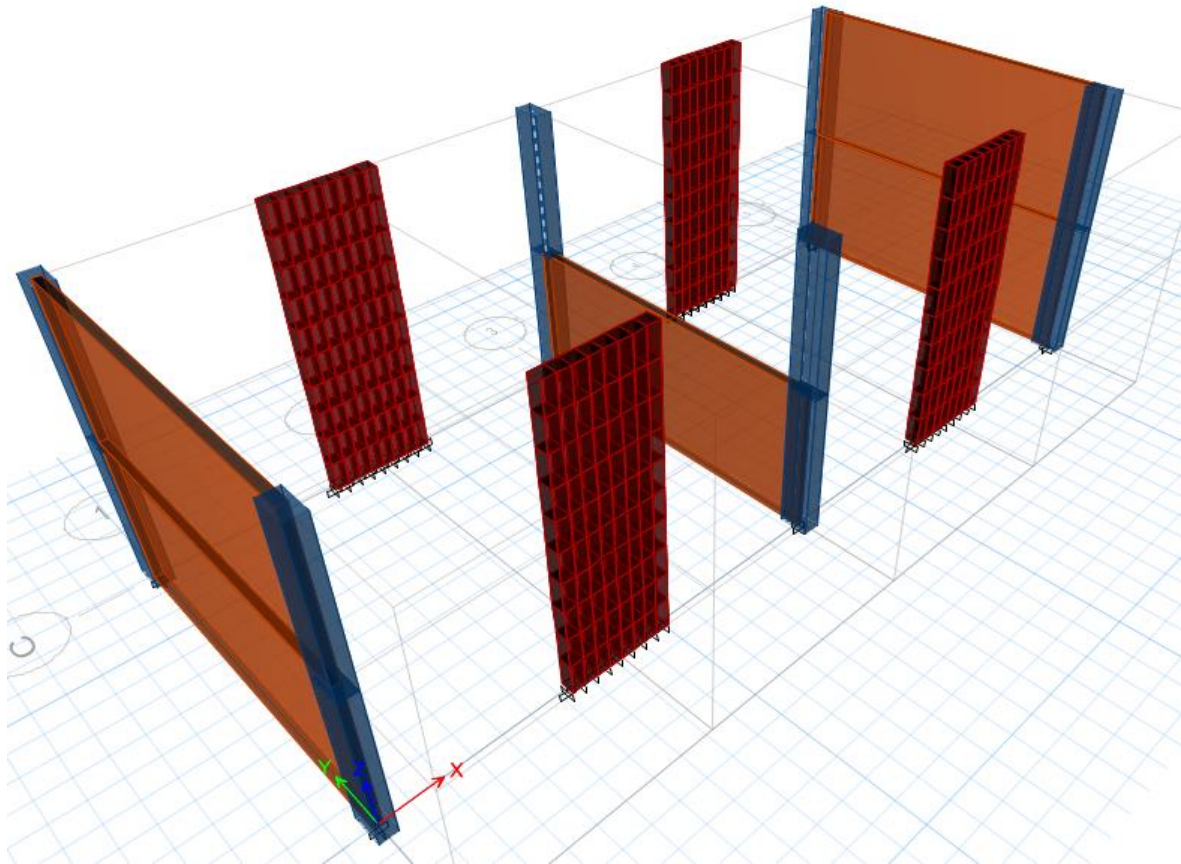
Vista en planta de los muros de corte en la dirección “X” del módulo 2.
